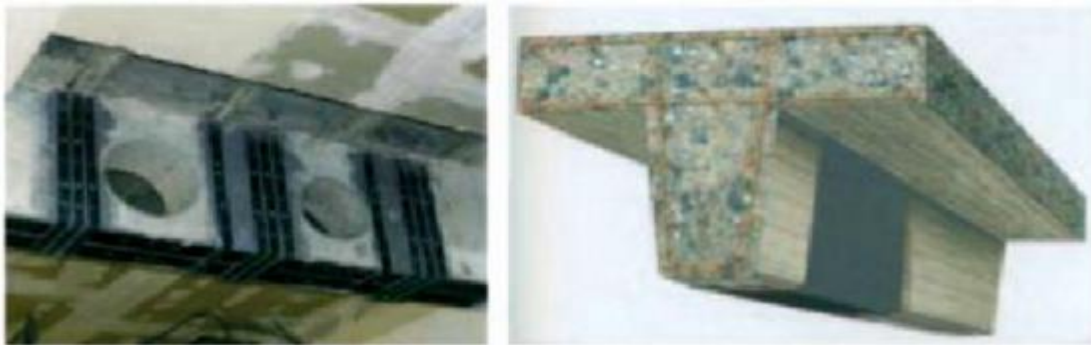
Renforcement de poutres vis-à-vis de l'effort tranchant. [CHE 15]
